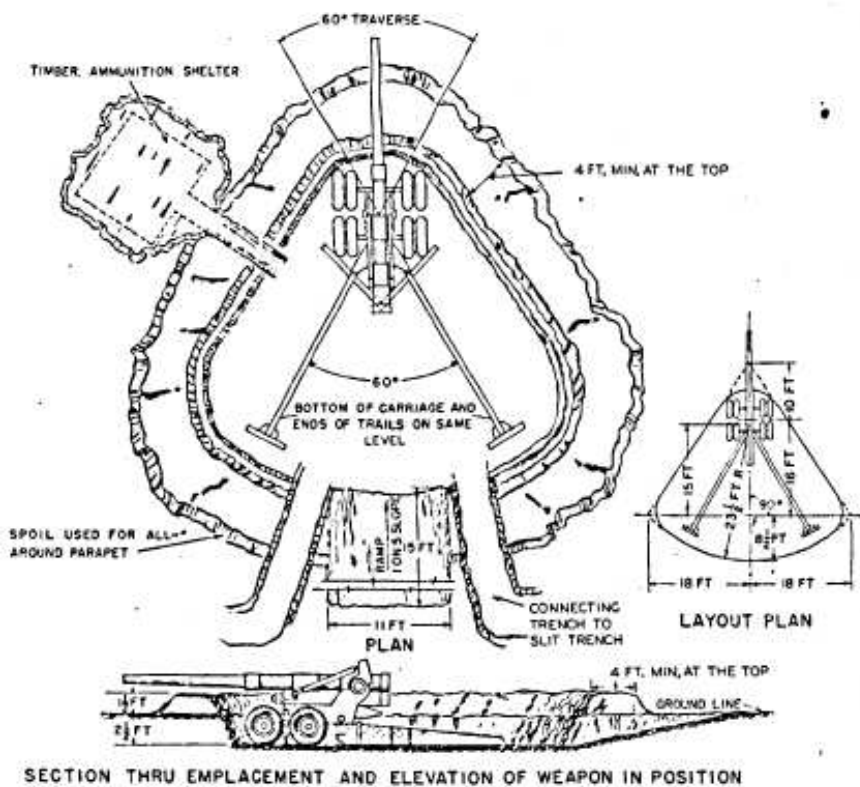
Druhá varianta palebného postavení houfnice ráže 105 mm na okraji cesty (palba je vedena napříč cesty)
